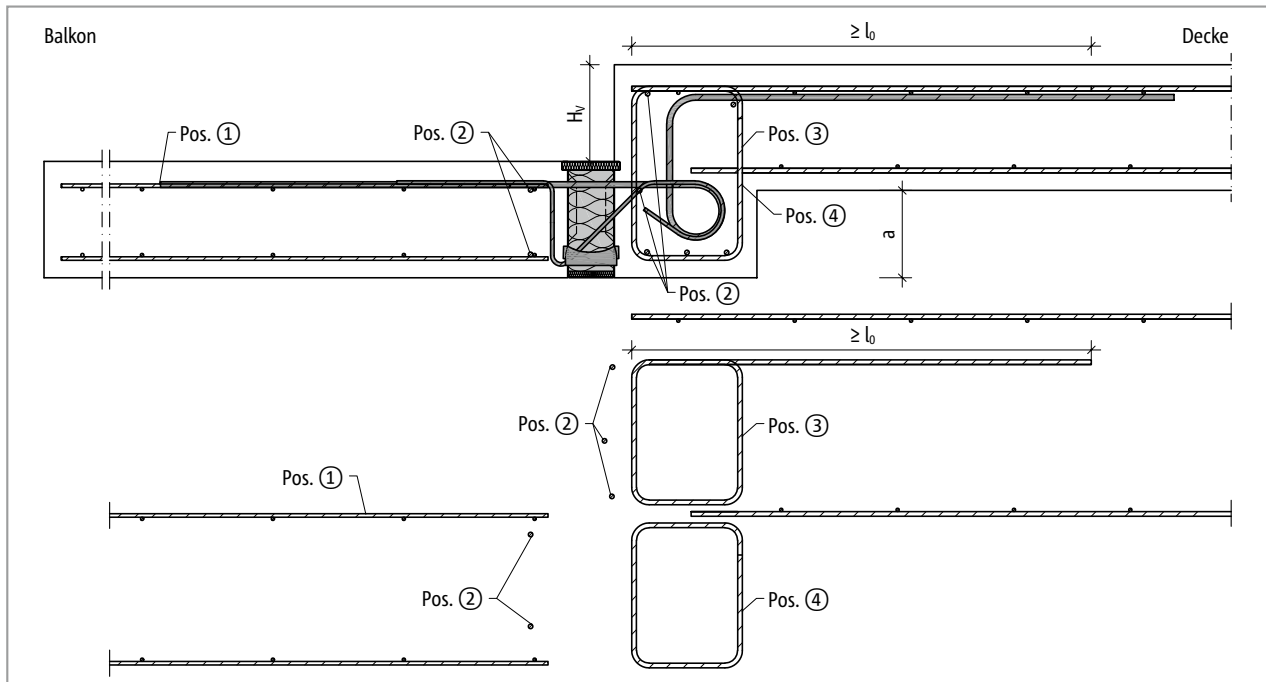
Schöck Isokorb® T Typ K-HV: Bauseitige Bewehrung
